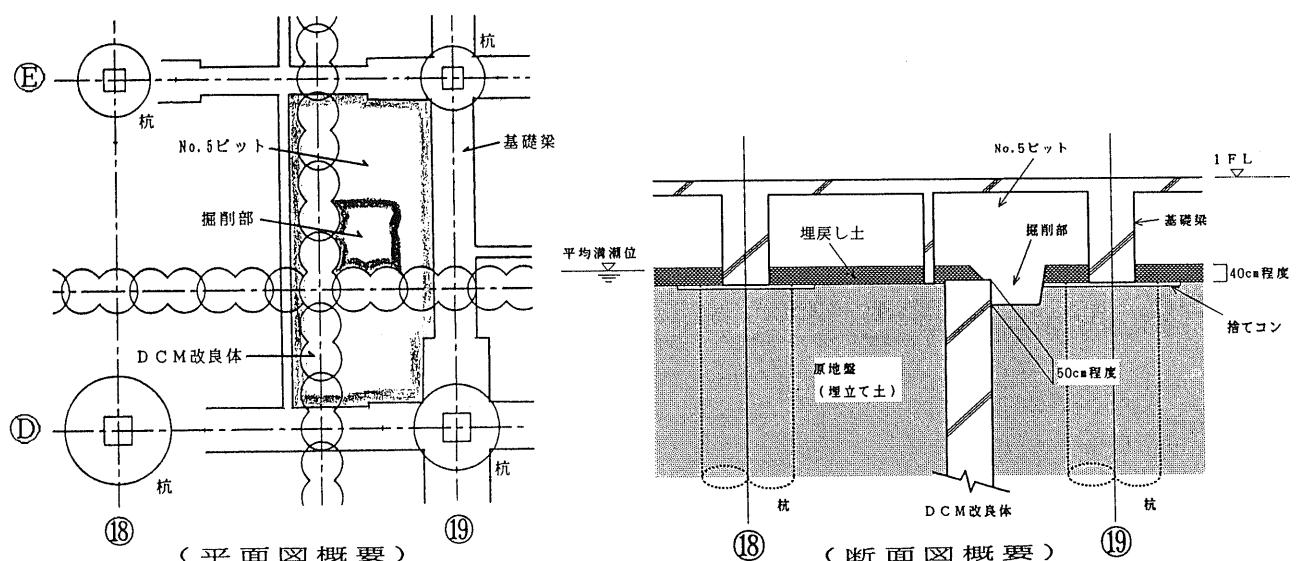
No. 5ピットでの改良体の掘り出し調査の断面図および平面図
